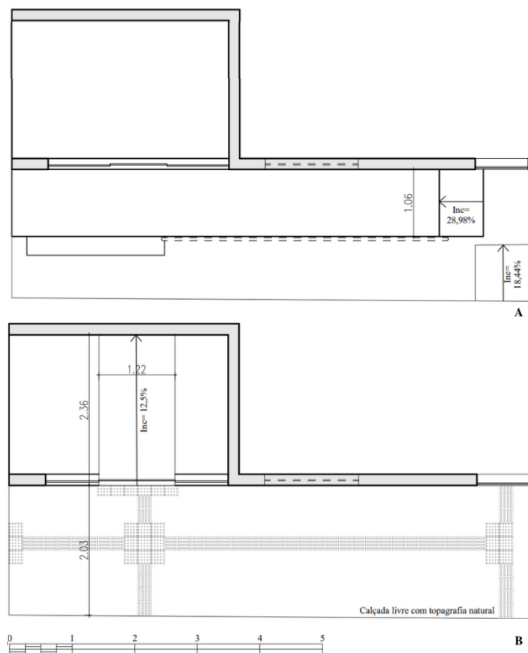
Proposta para Reforma da Rampa de Entrada da UEAN.
